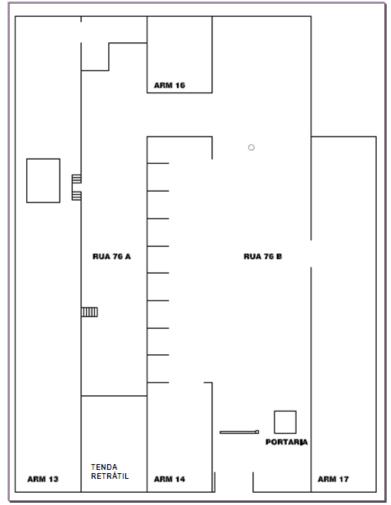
Croqui (planta baixa) do Entreposto de Recicláveis.
